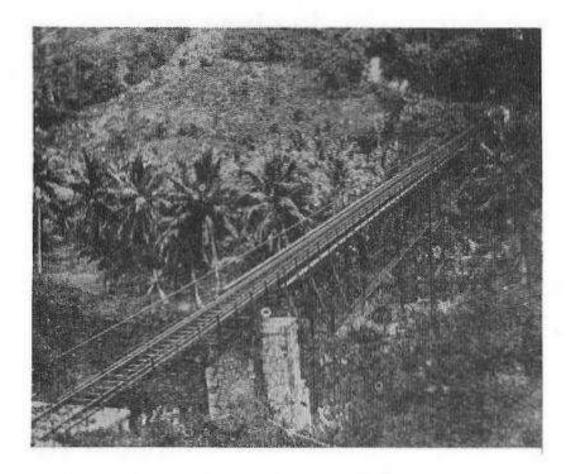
Viaducto de Guajataca entre Quebradillas e Isabela. De este gran puente quedan sólo los estribos, pues fue desmantelado para vender el acero tras la quiebra definitiva de la American Railroad Co. en 1957. R.O.P. c.1925.
